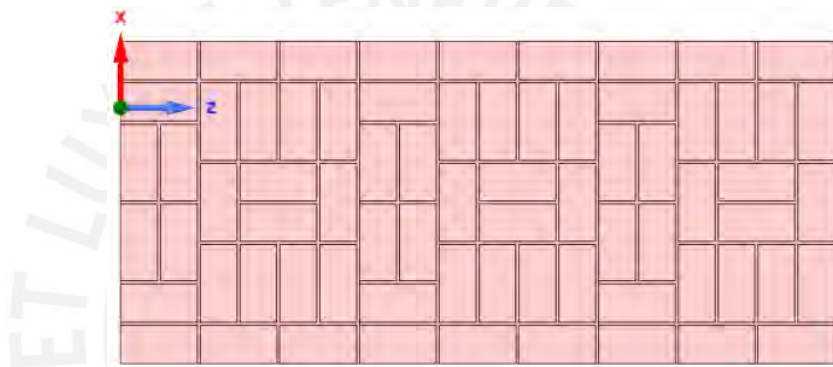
Vista en planta de vereda adoquinada del Jr. Arequipa
